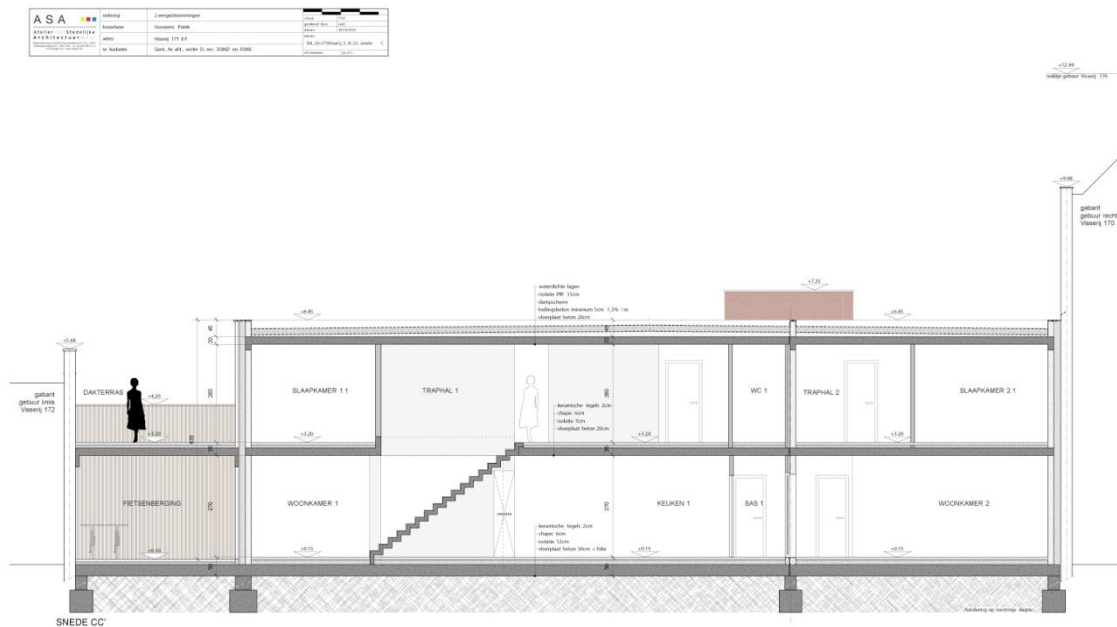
Uitsnede uit het plan bestaande toestand. (bron: opdrachtgever)
